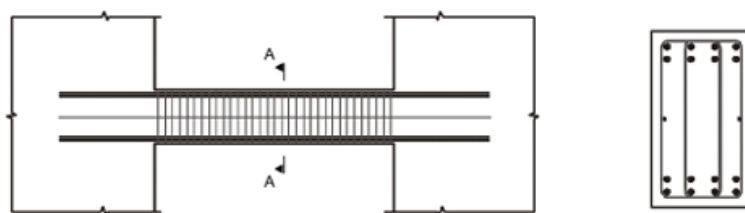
Viga de acoplamento armada convencionalmente adaptado de [7]
